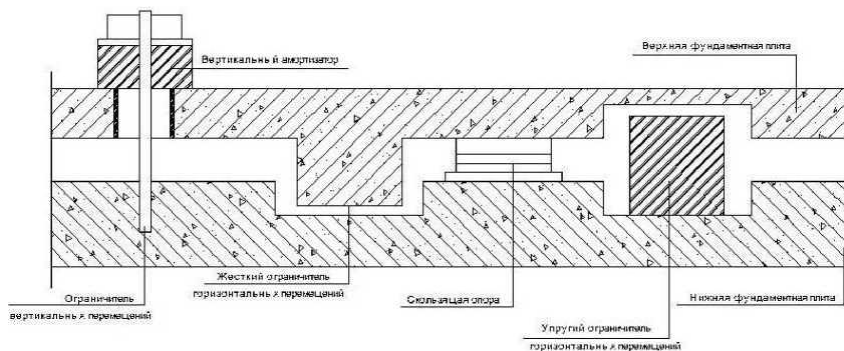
Схема элементов сейсмоизолирующего скользящего пояса
